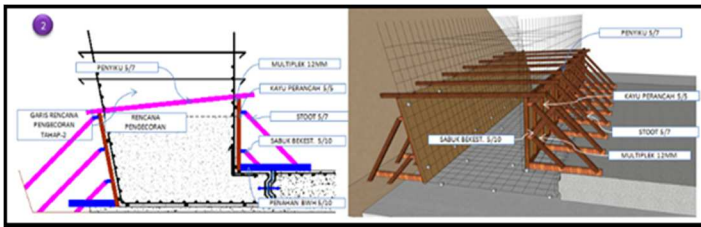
Tampak proses pengecoran lantai bangunan pelimpah (*spillway*)
